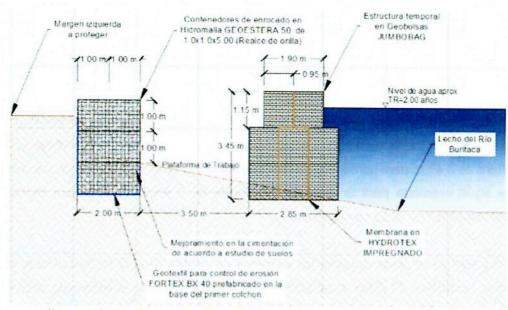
Estructura propuesta sector 2 Alternativa 2 (Sección 0+520)
